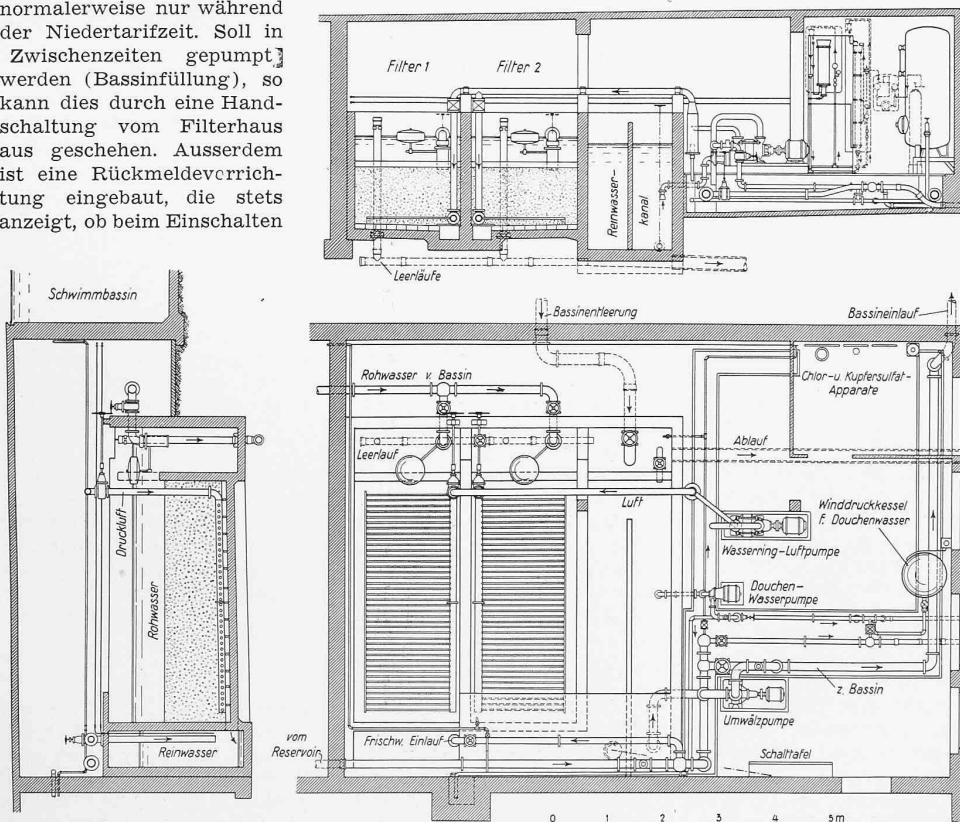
Schnellfilteranlage, Grundriss und Schnitte, 1:125. — Ing. GUYER & NAEGELI, Winterthur.
